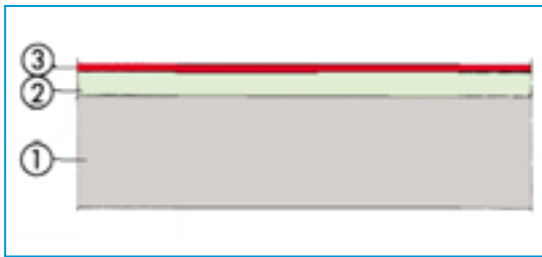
Bodenaufbau mit Abdichtung durch Bodenbelag:
